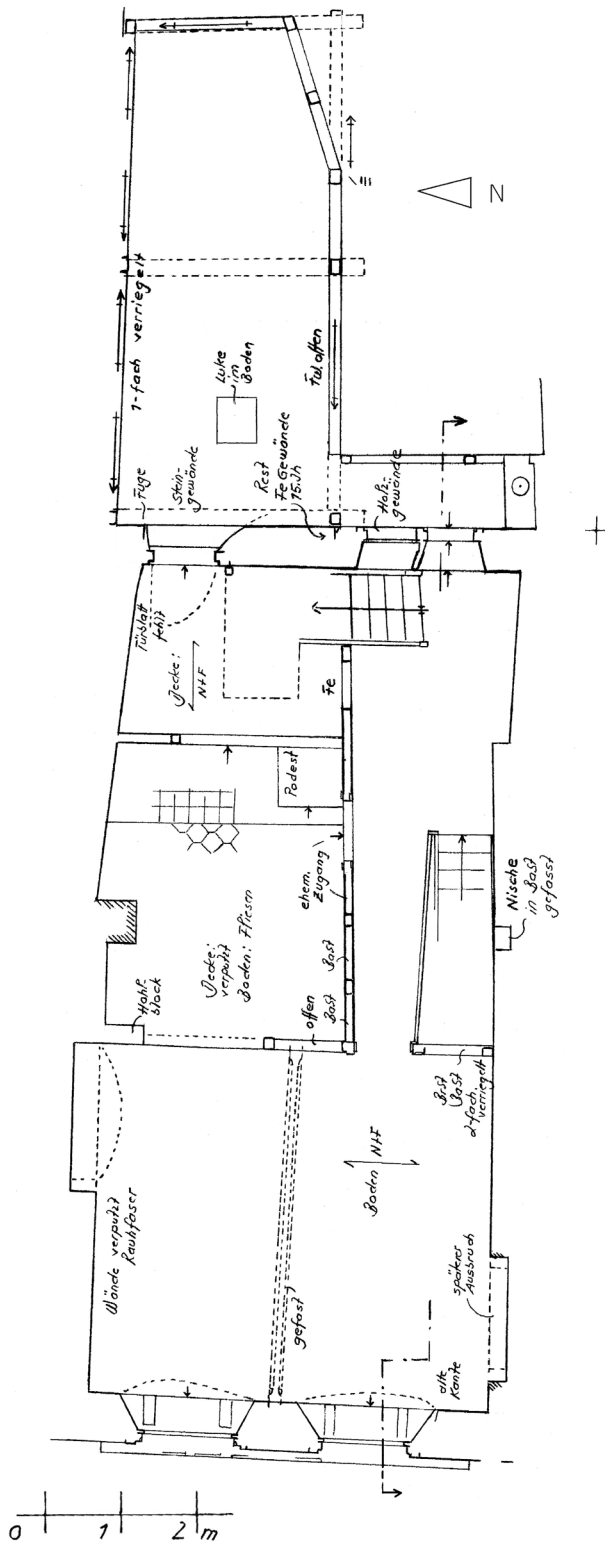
Adlegasse 3, Grundriss 1. Obergeschoss.
